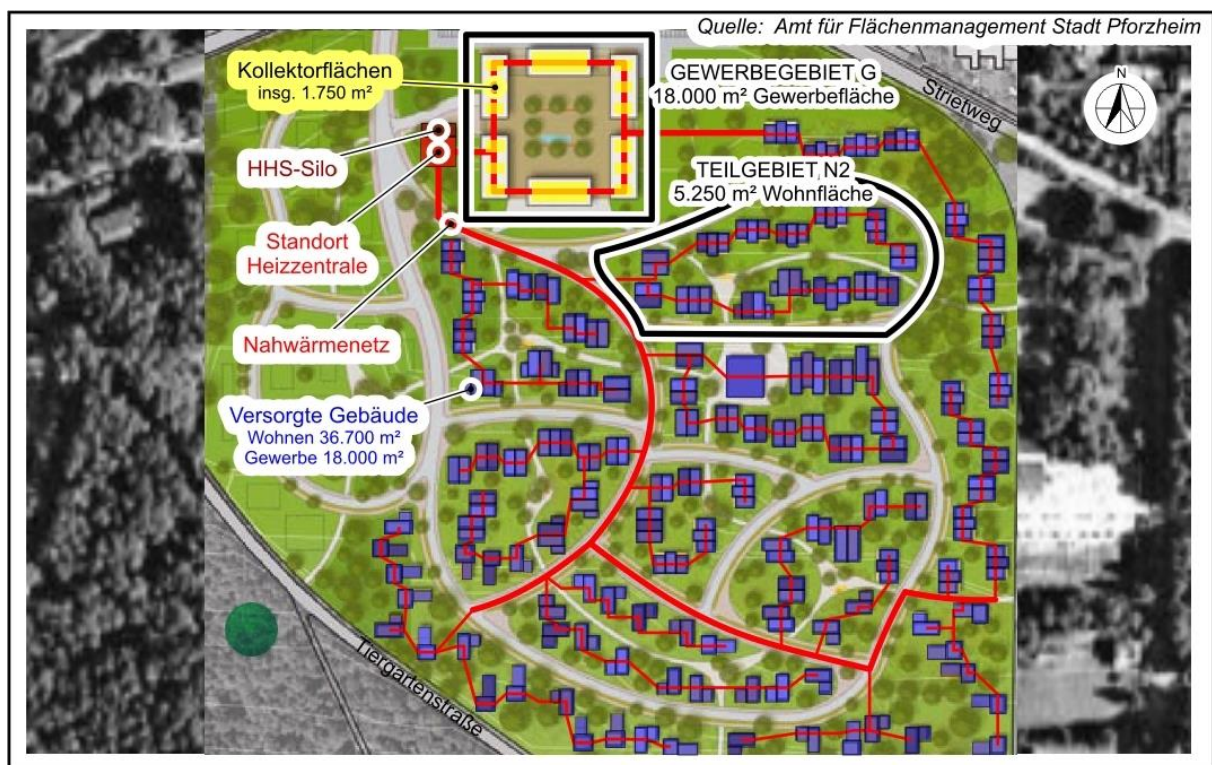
Lageplan Pforzheim, Neubaugebiet Buckenberg Kaserne
